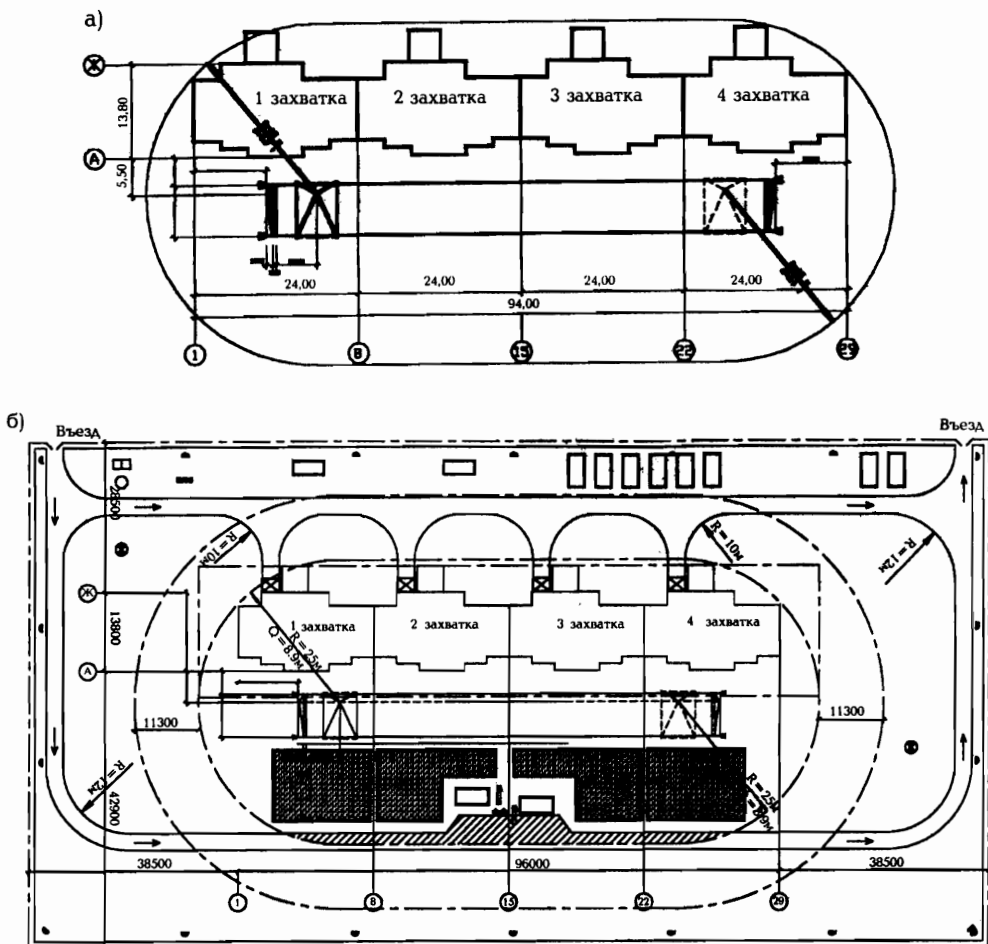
Фрагменты стройгенплана на монтаж надземной части многоэтажного четырехсекционного здания: а - схема привязки башенного крана и деления объекта на захватки; б - стройгенплан на период возведения надземной части здания
